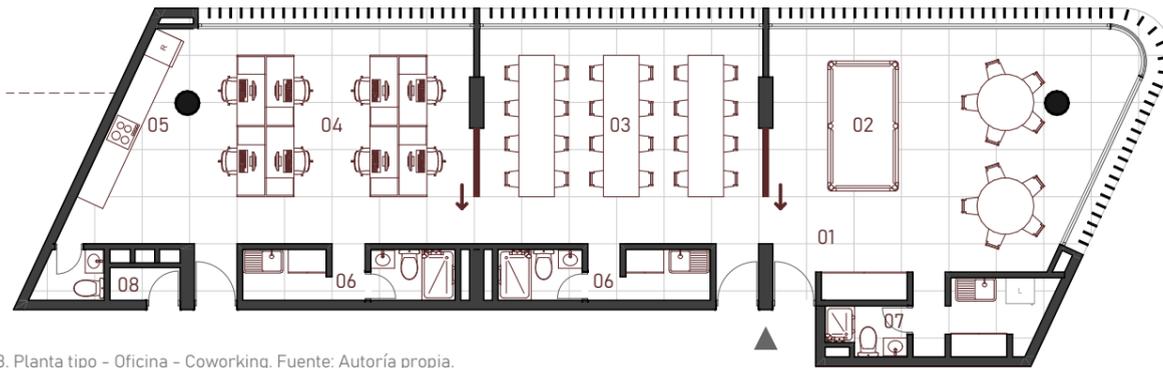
Planta tipo - Oficina - Coworking. Fuente: Autoría propia.
